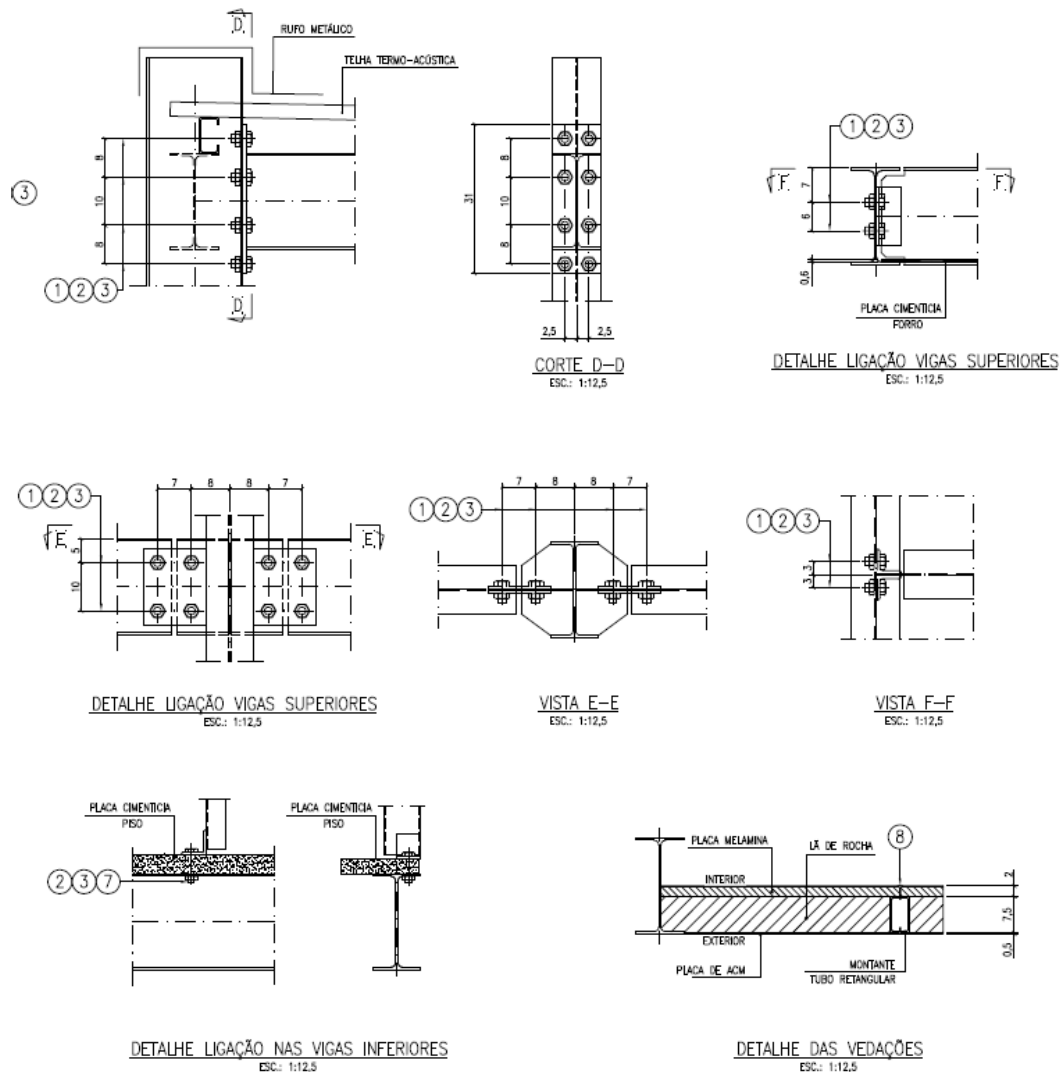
Detalhes Projeto Executivo Vigas e vedações-
